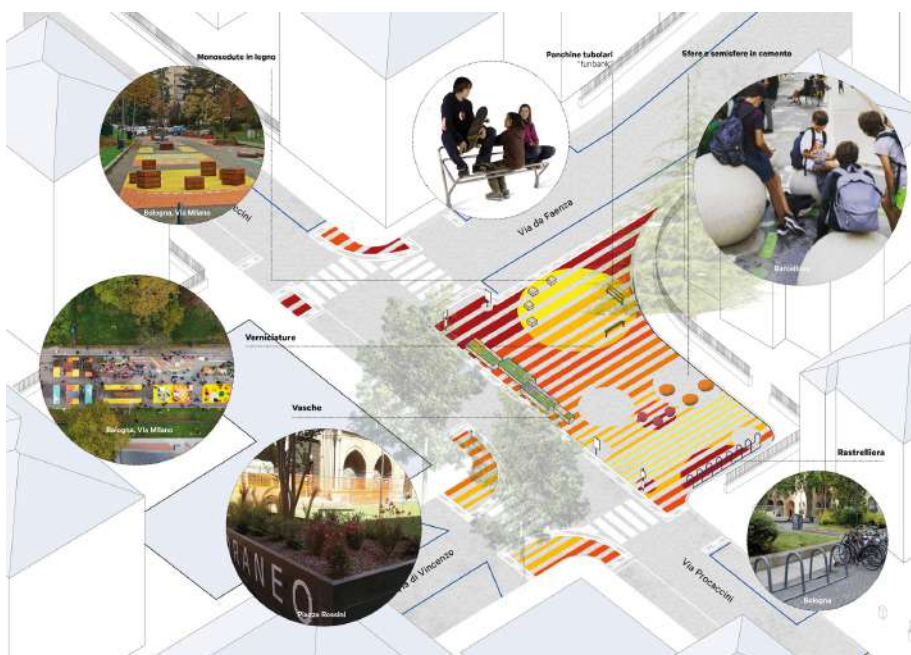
Schema progettuale dell'intervento. Fonte: Fondazione di Innovazione Urbana.
